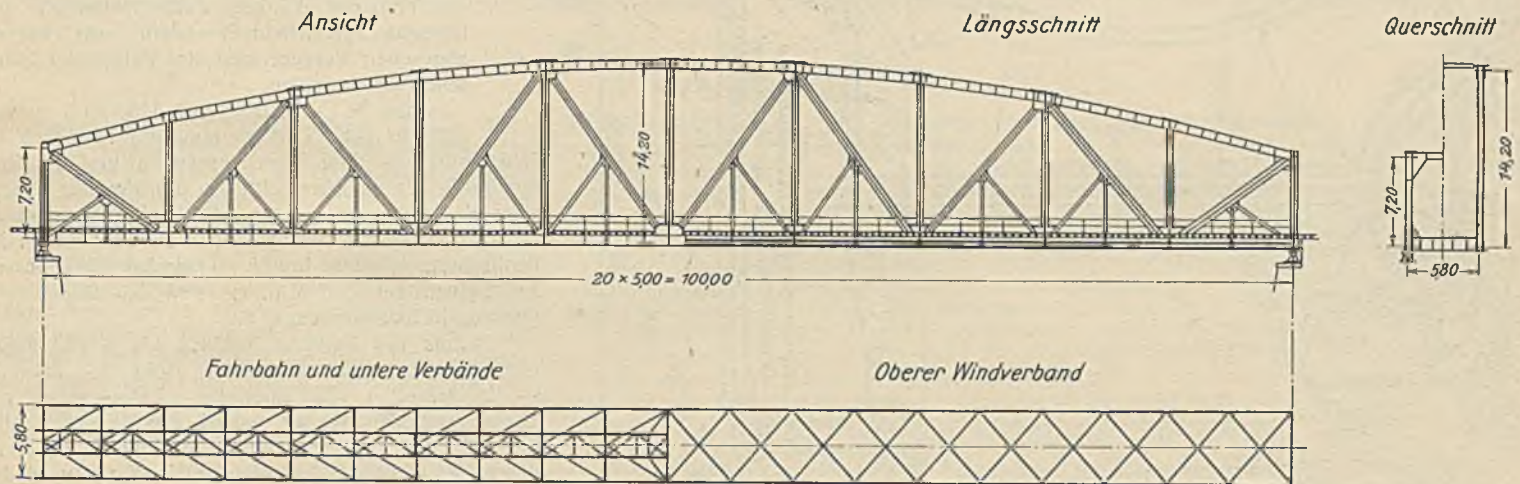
Übersichtszeichnung einer der 100-m-Brücken.
